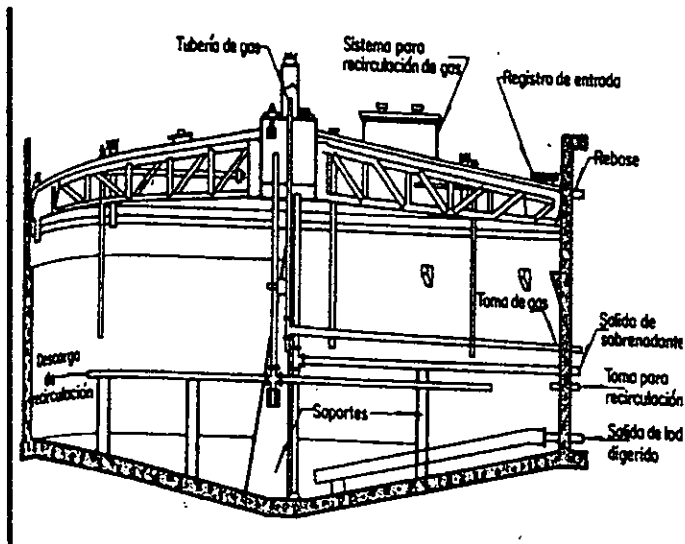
Corte transversal de un digestor cilíndrico.
